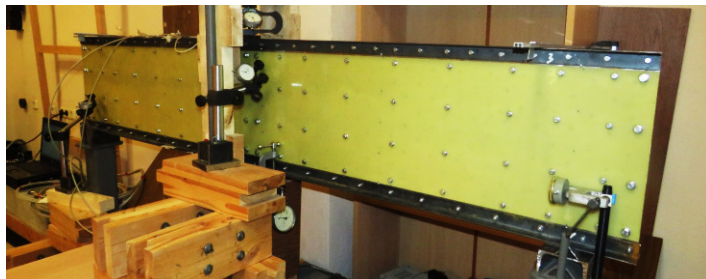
Общий вид стальной балки, усиленной композитными пластинами
